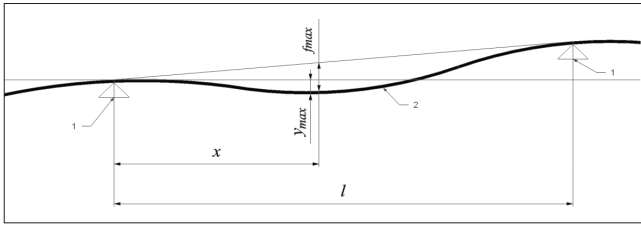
Схема провисания трубопровода: 1 – промежуточная опора; 2 – трубопровод
